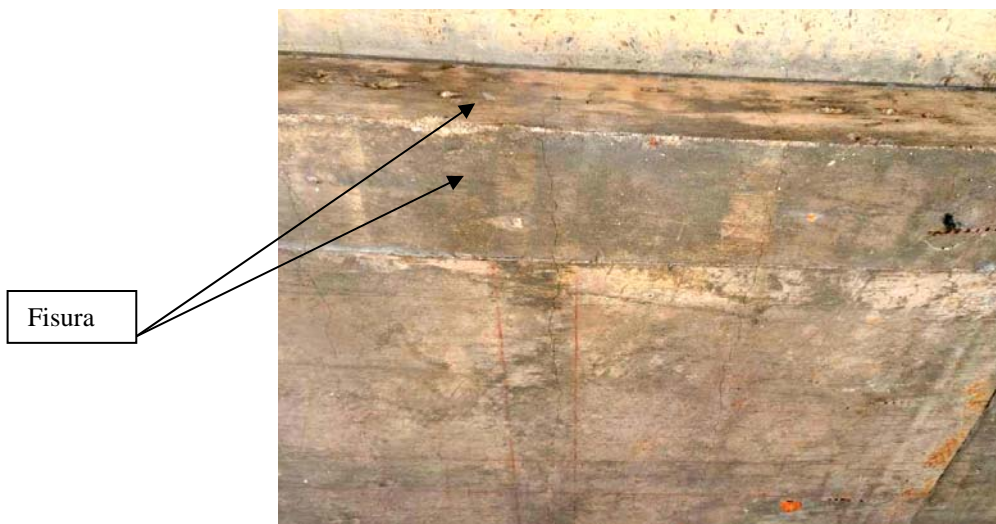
Fisura en fondo y cara lateral de viga transversal extrema
